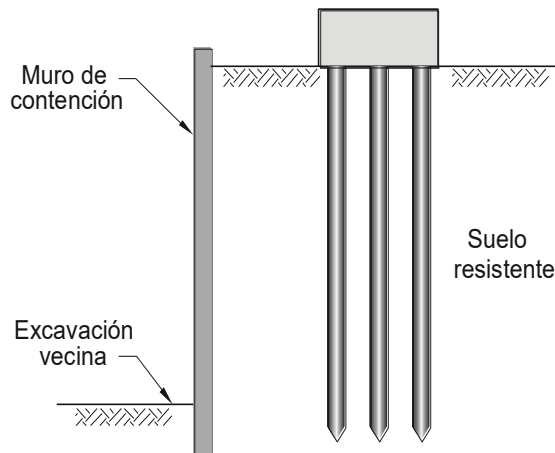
, APLICACIÓN DE PILOTES PARA ESTABILIZACIÓN DE ESTRUCTURAS
